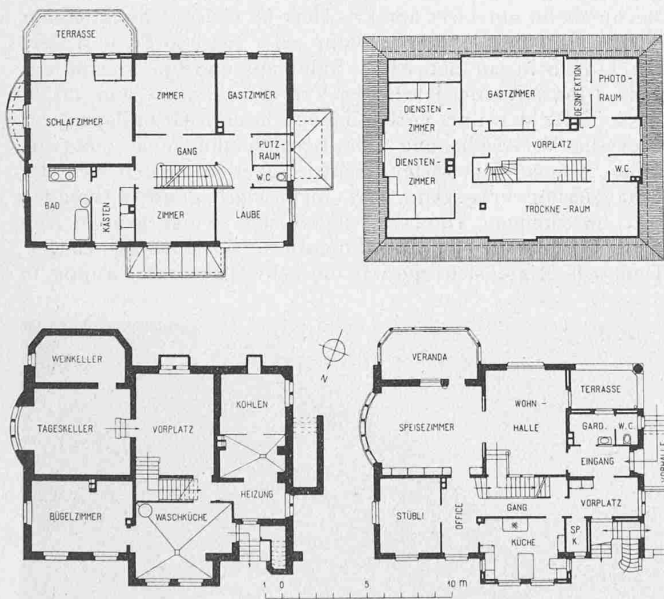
bis 4. Grundrisse des Hauses Dr. Frischknecht. — 1 : 400.
